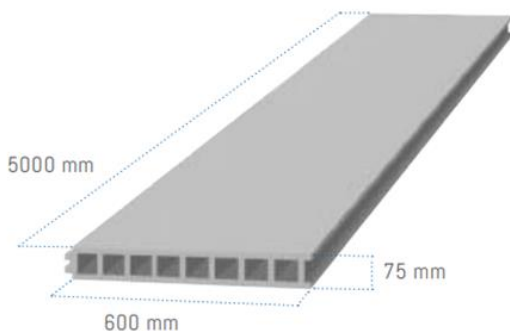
Imagen de muro prefabricado de concreto para exteriores liso [Asloc], (2019). Recuperado de <https://www.grupobasica.com/productos/prefabricado-de-concreto/>
